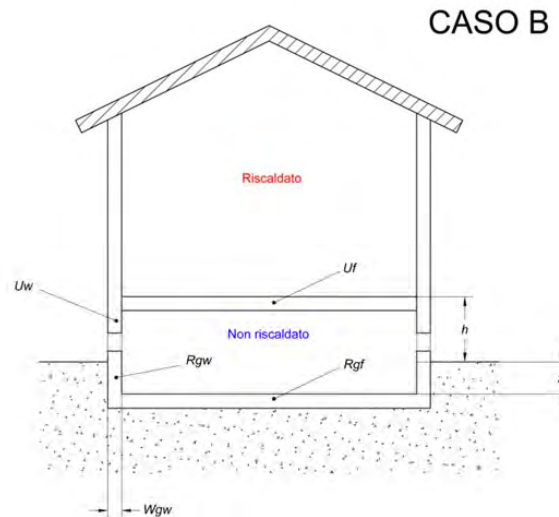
Basamento CASO B - Pavimento su spazio aereo
